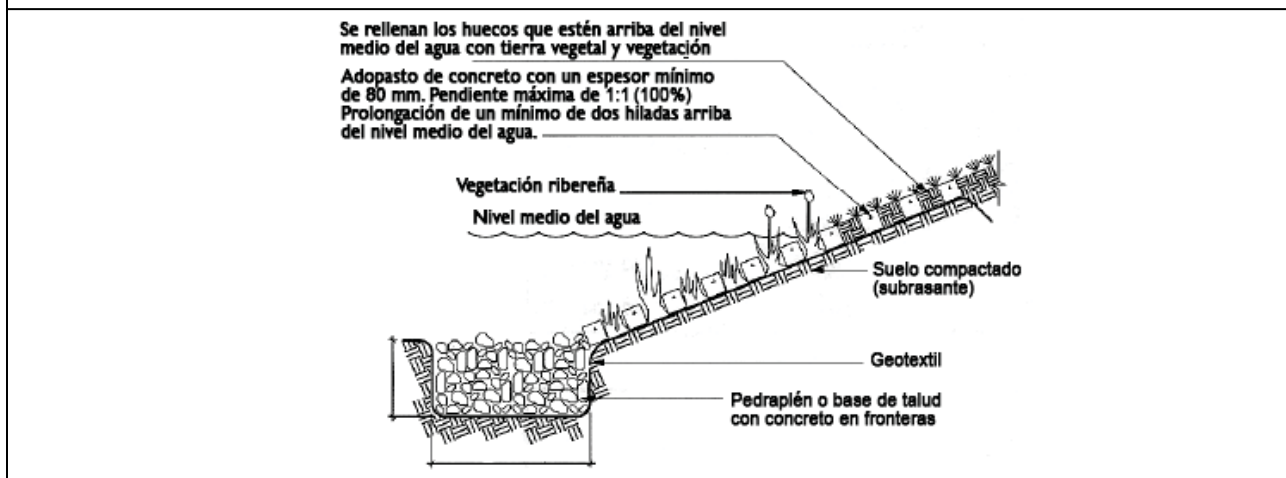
ESTABILIZACIÓN DE UN MARGEN DE ARROYO MEDIANTE ADOPASTOS DE CONCRETO
